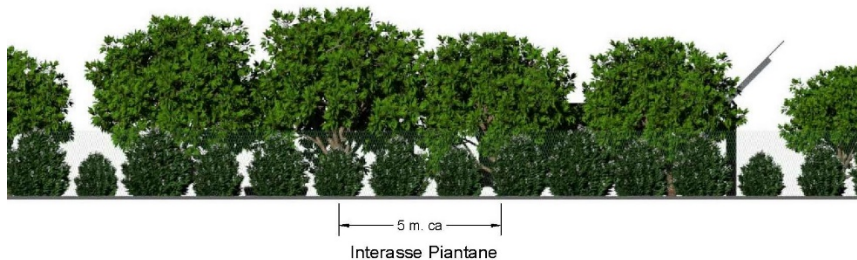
Prospetto recinzione perimetrale con mitigazione
